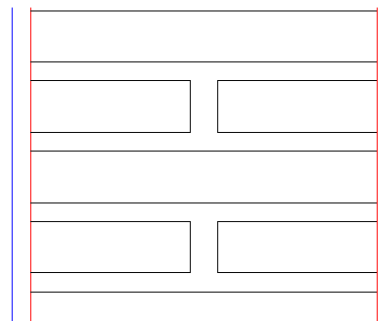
Detalle de colocación de los ladrillos a lo ancho de los muros de los ejes A, B, C, D, E y F en el 3er. piso (muros de 39 cm de espesor).
